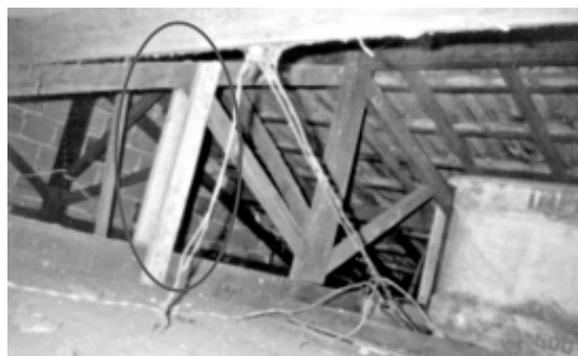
Habitação ampliada: reaproveitamento de madeira em peças estruturais das tesouras do telhado, na parte original
